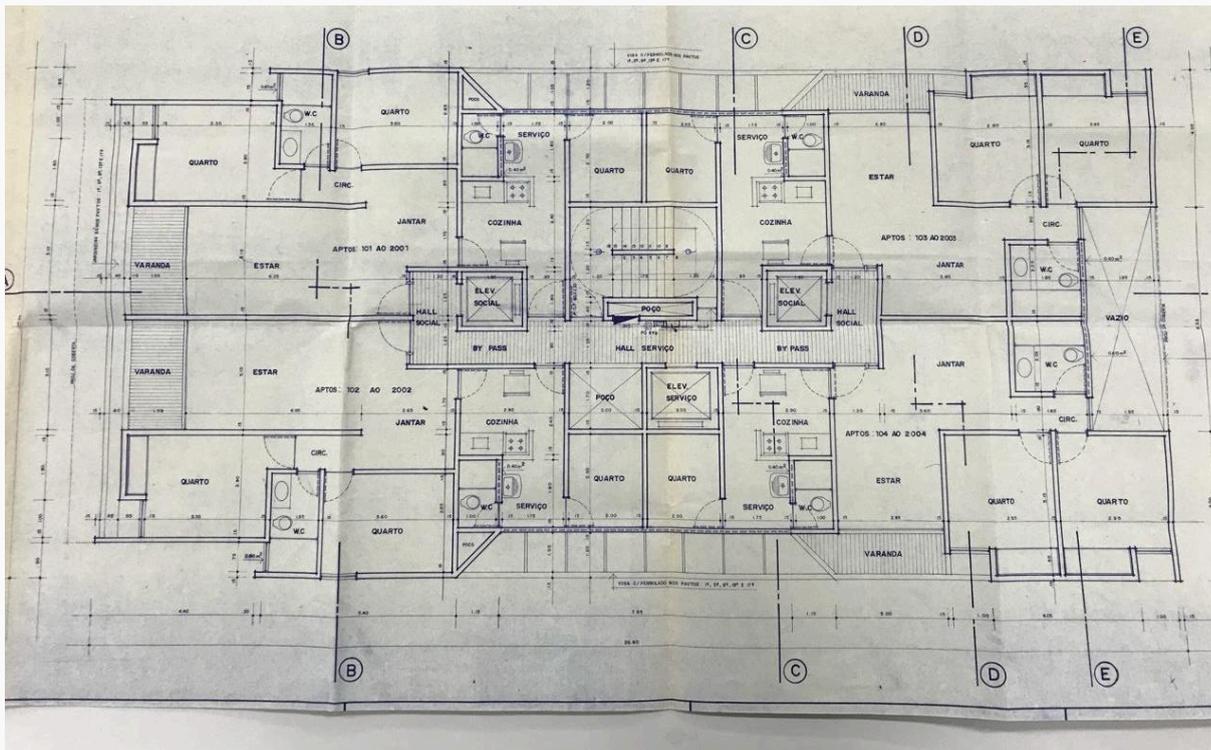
Planta Baixa do Edifício Sobrado Setúbal.
